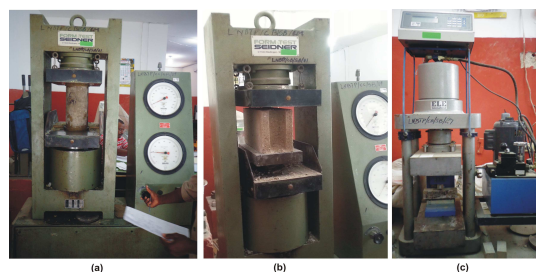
Essai d'écrasement à la presse sur (a) cylindres de béton, (b) blocs de ciment et (c) éprouvettes de mortier
